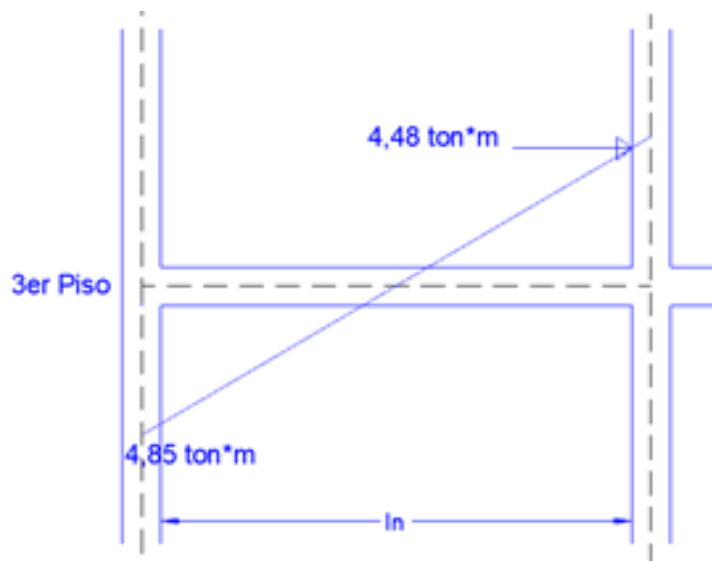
11 Momentos en los extremos de las vigas del sistema aporticado.
